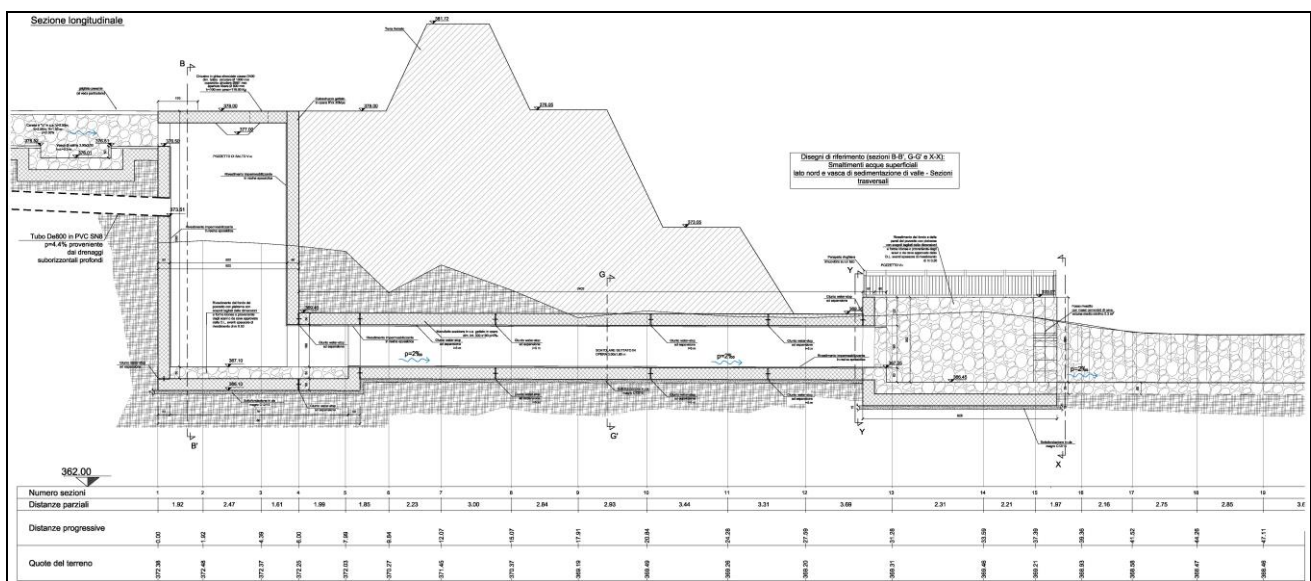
Compluvio nord – Vasca Vn0 e canale di scarico – tratto 1
